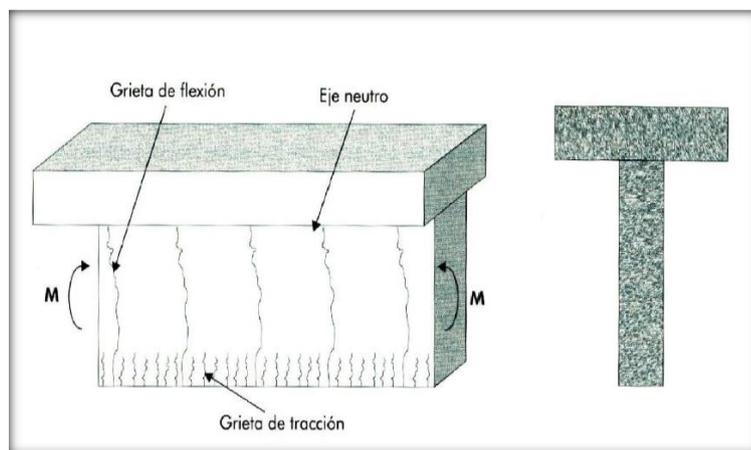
Grietas por flexión y tracción de un elemento.
